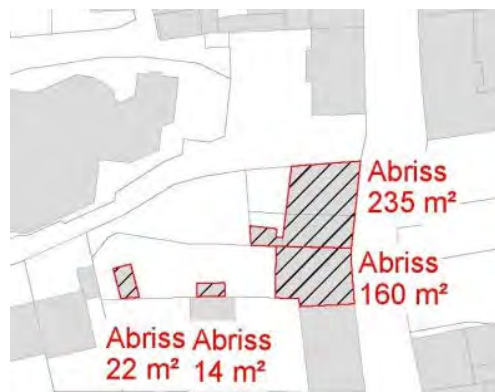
Gebäuderückbau Hochstraße, o.M.
